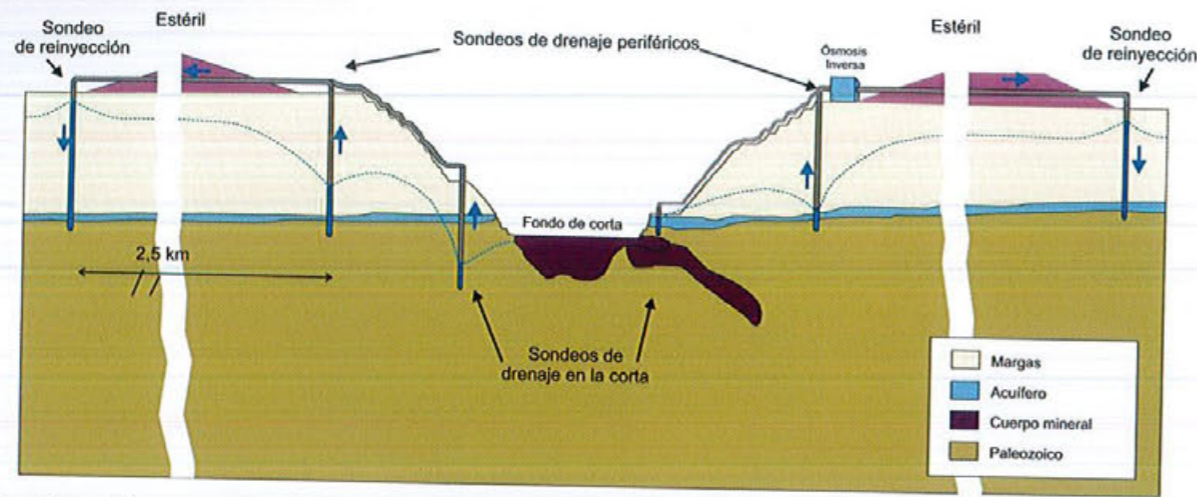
Sección esquemática del Sistema de Drenaje y Reinyección.
